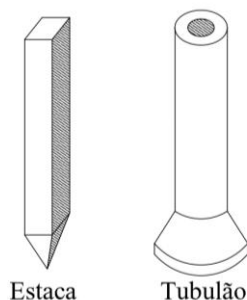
Tipos de fundações profundas (Fonte: Próprio autor).
